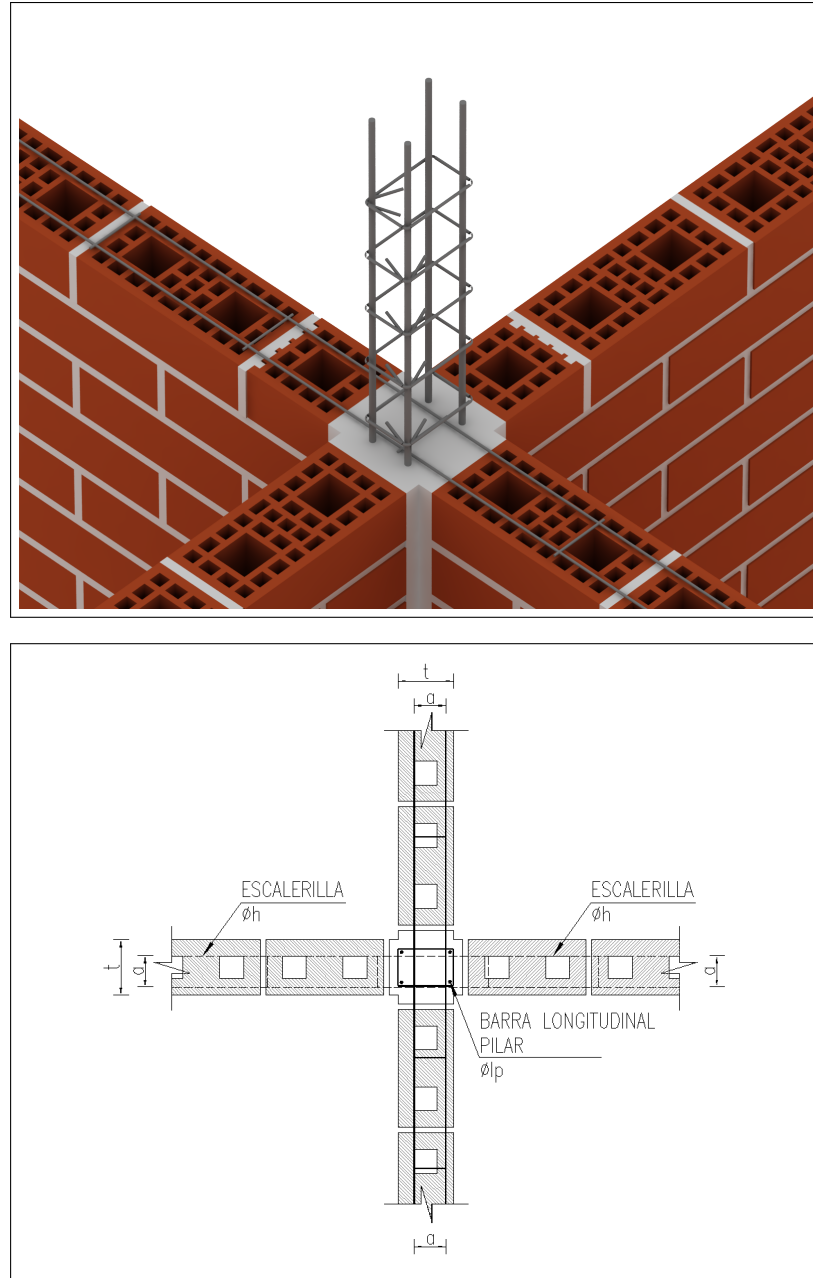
Detalle de las escalerillas para el encuentro de muros en Cruz
